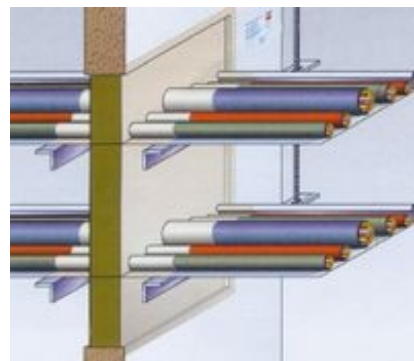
Пример заделки кабельных проходок в стенах и перекрытиях.
